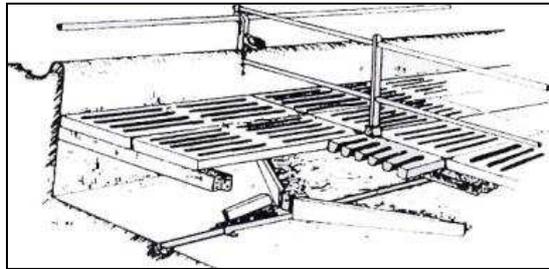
Raschiatore meccanico installato al di sotto del pavimento fessurato
